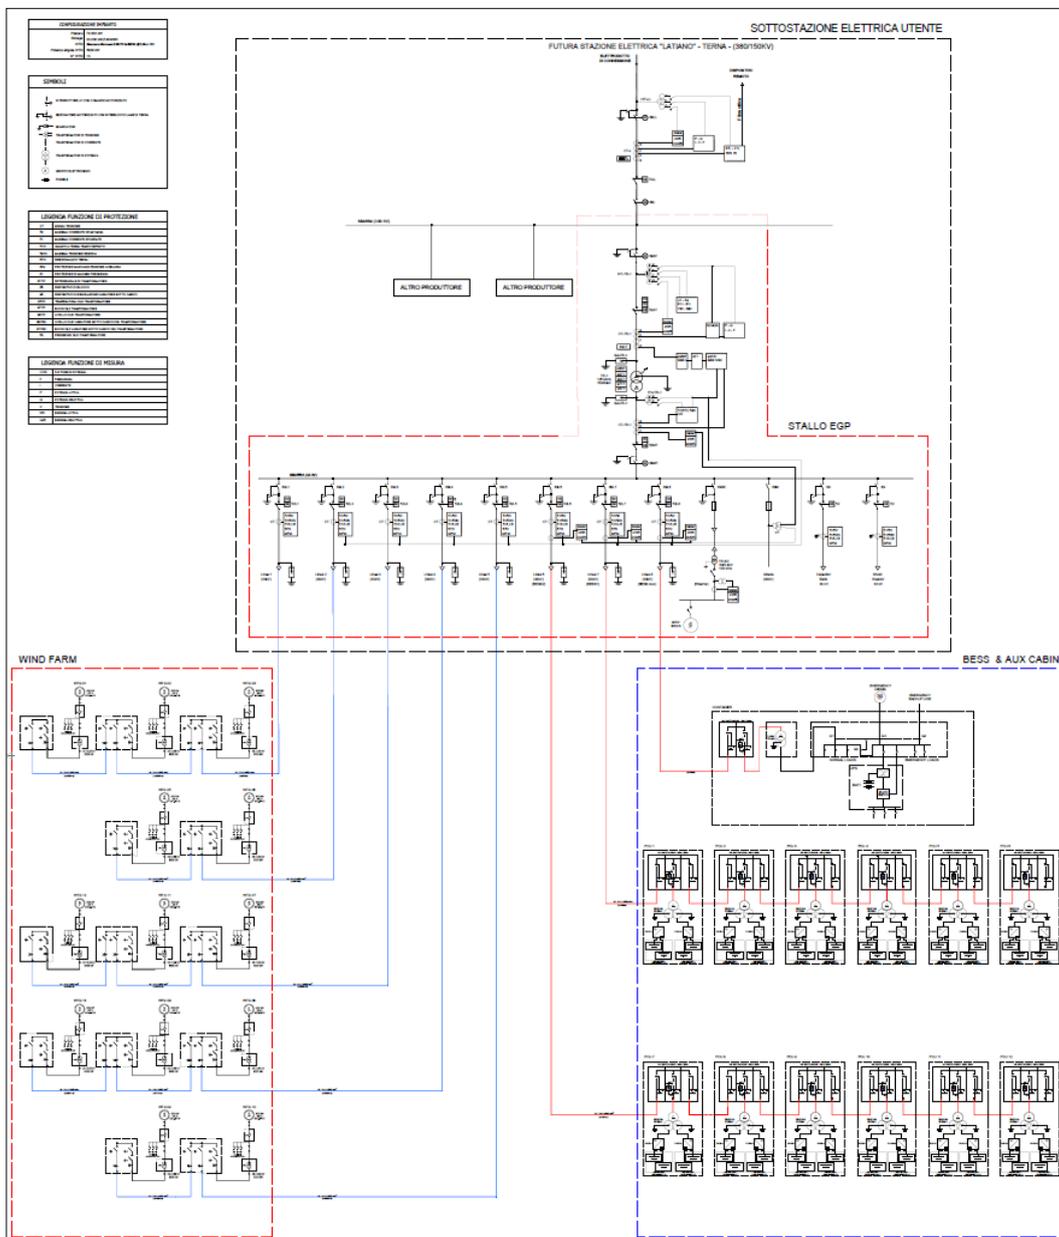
schema elettrico di collegamento tra WTG - SSU - SE - BESS
